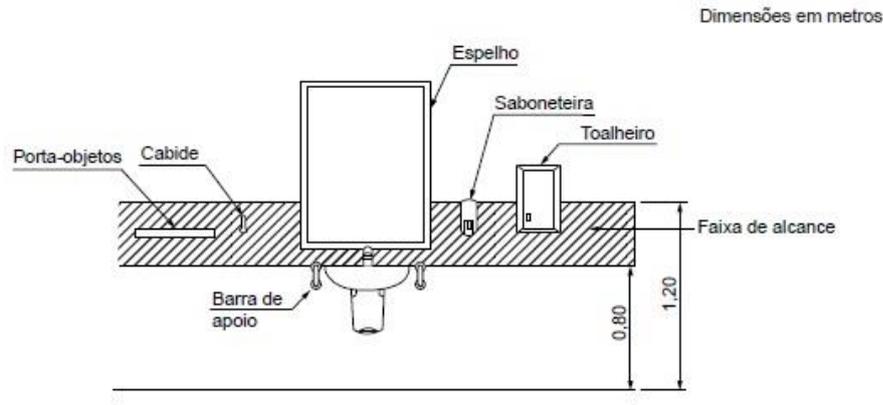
Faixa de alcance de acessórios junto ao lavatório – Vista frontal
